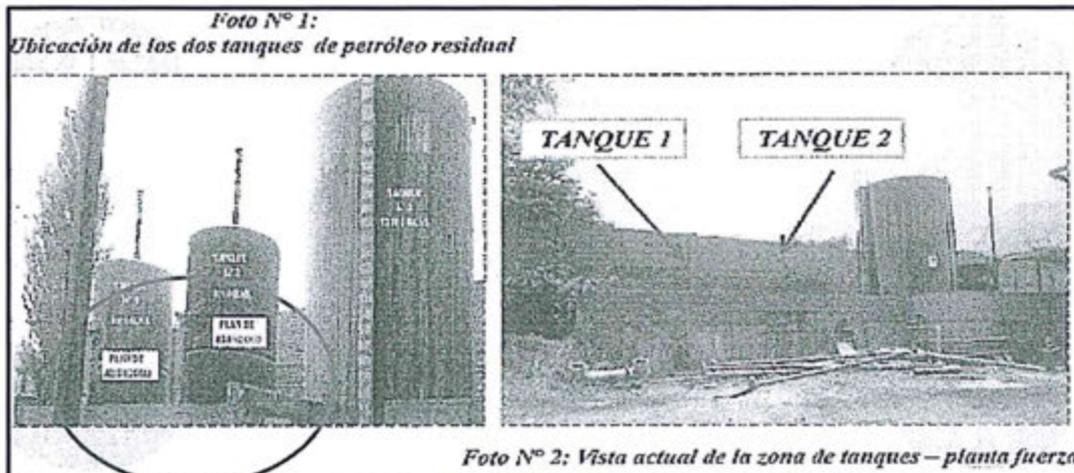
Vista actual de la zona de tanques – planta fuerza
